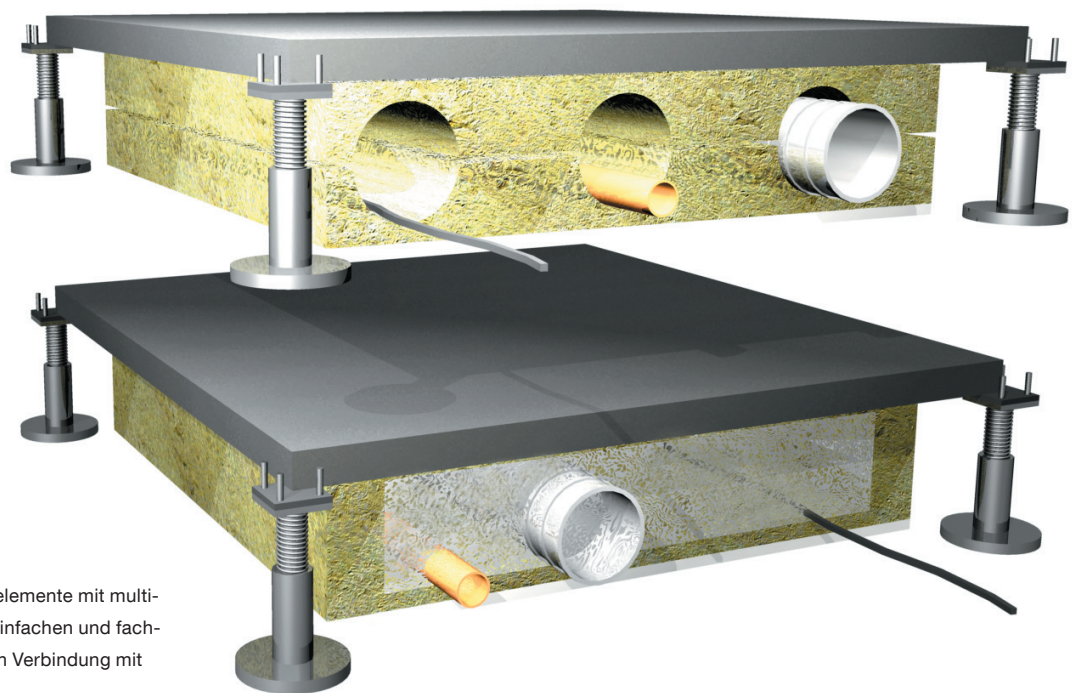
vorgefertigte Bodenelemente mit multifunktionalen Hohlräumen zur einfachen und fachgerechten Leitungsverlegung in Verbindung mit „klassischen“ Doppelböden.
